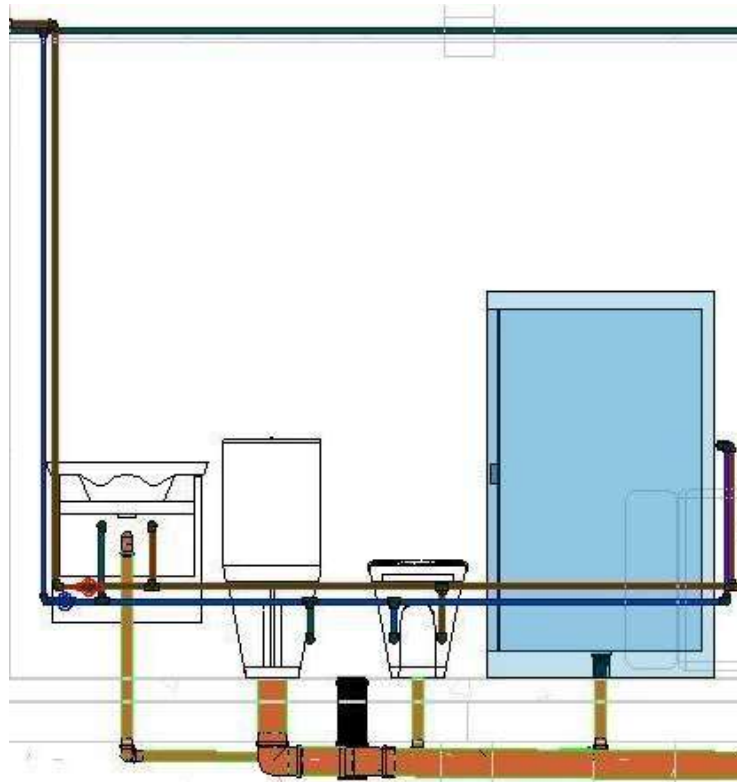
Vista lateral de distribución de instalaciones para núcleo húmedo.
